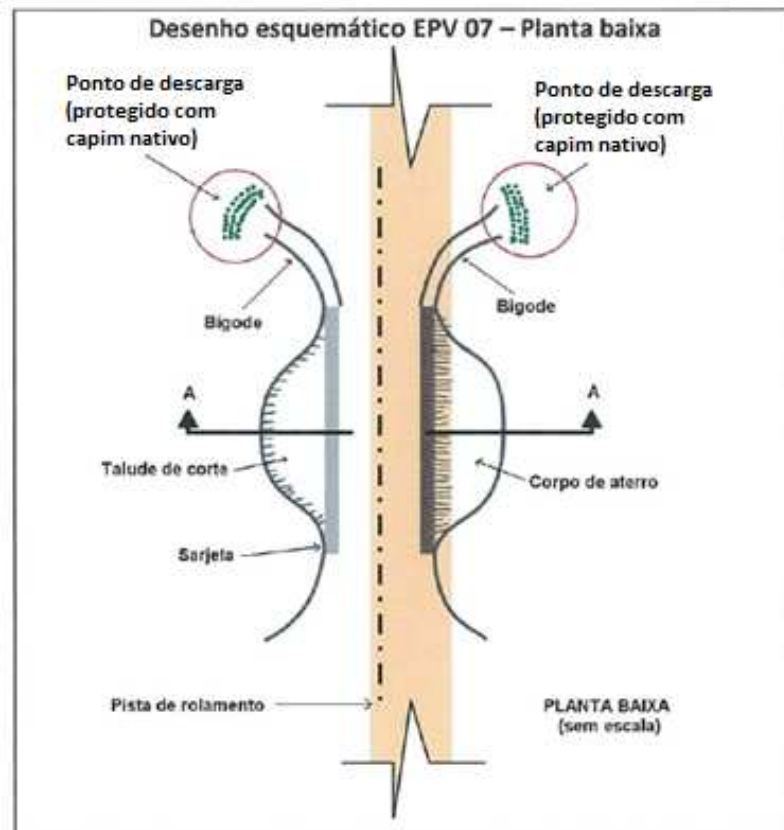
Desenho esquemático EPV 07 – Planta baixa
